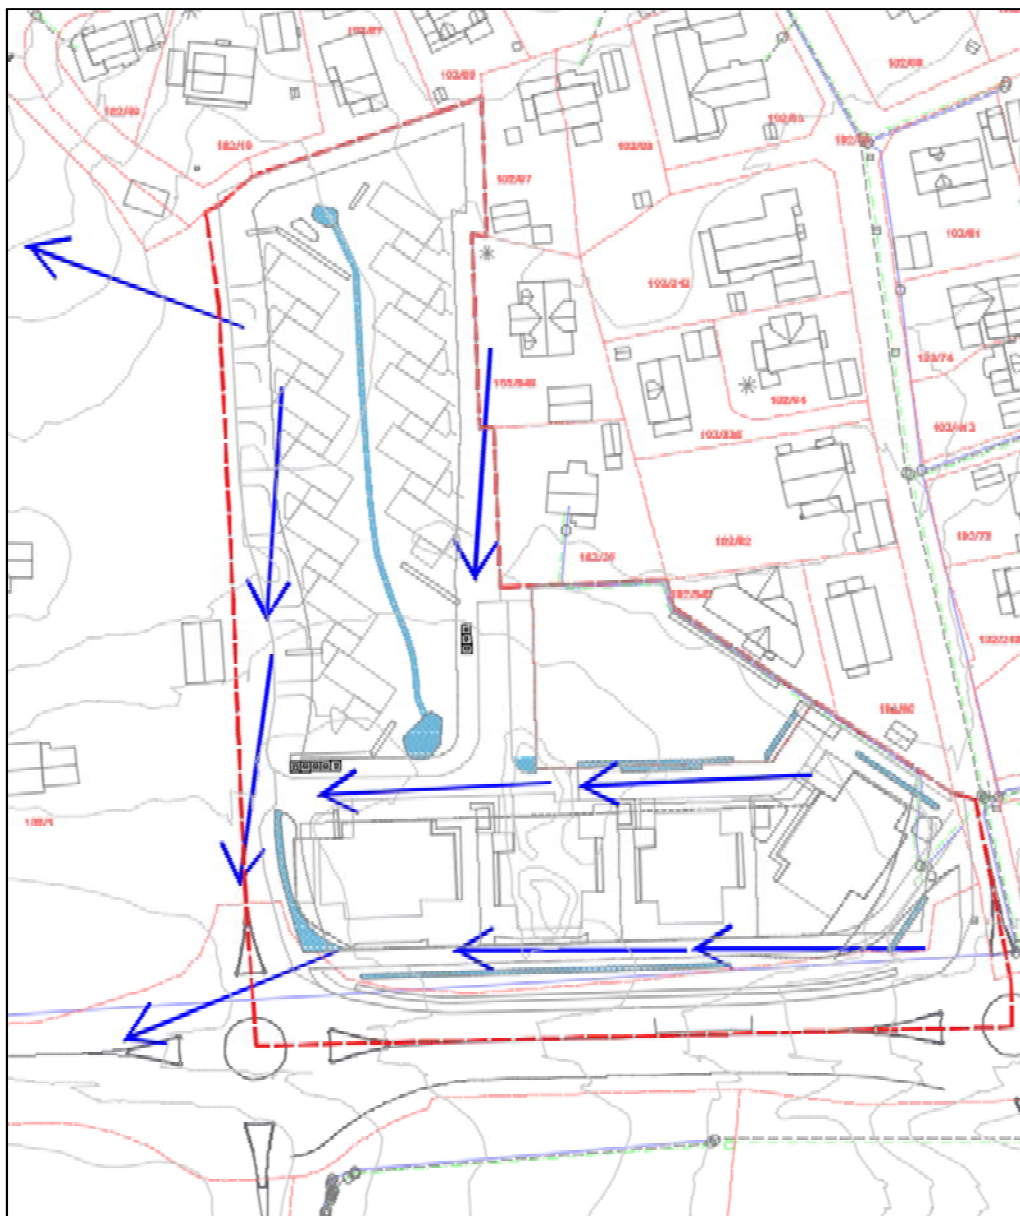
Utsnitt av plan for arealet mellom Nordbyveien og ekstra brannadkomst til de nye blokkene.
